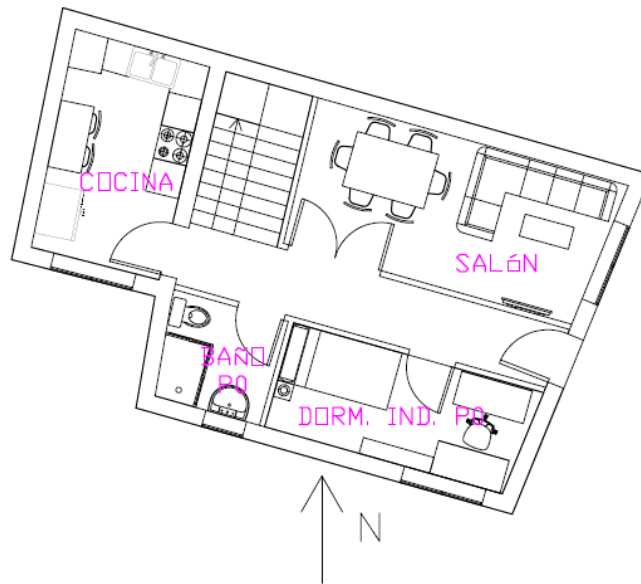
Distribución de la planta P0 de la vivienda. Fuente: elaboración propia.
